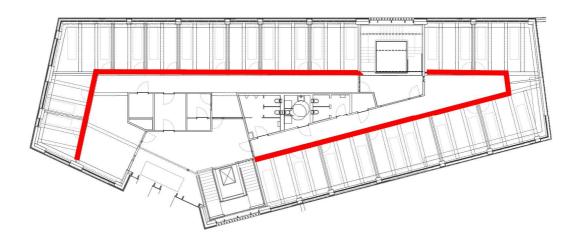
Grundriss EG Haus A – Einsatz von Trennwänden aus wiederverwendeten Bauteilen (IBUS Architekten)
